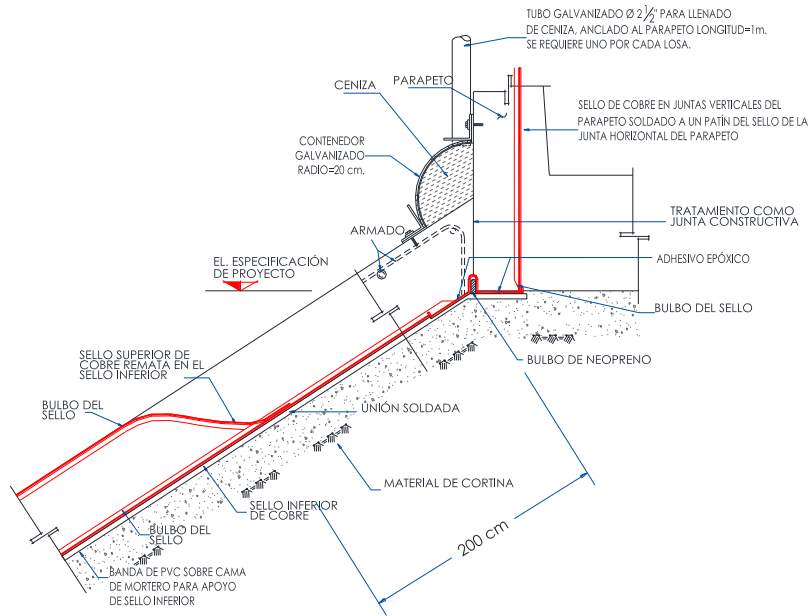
Junta Losa de Cara de Concreto – Parapeto
